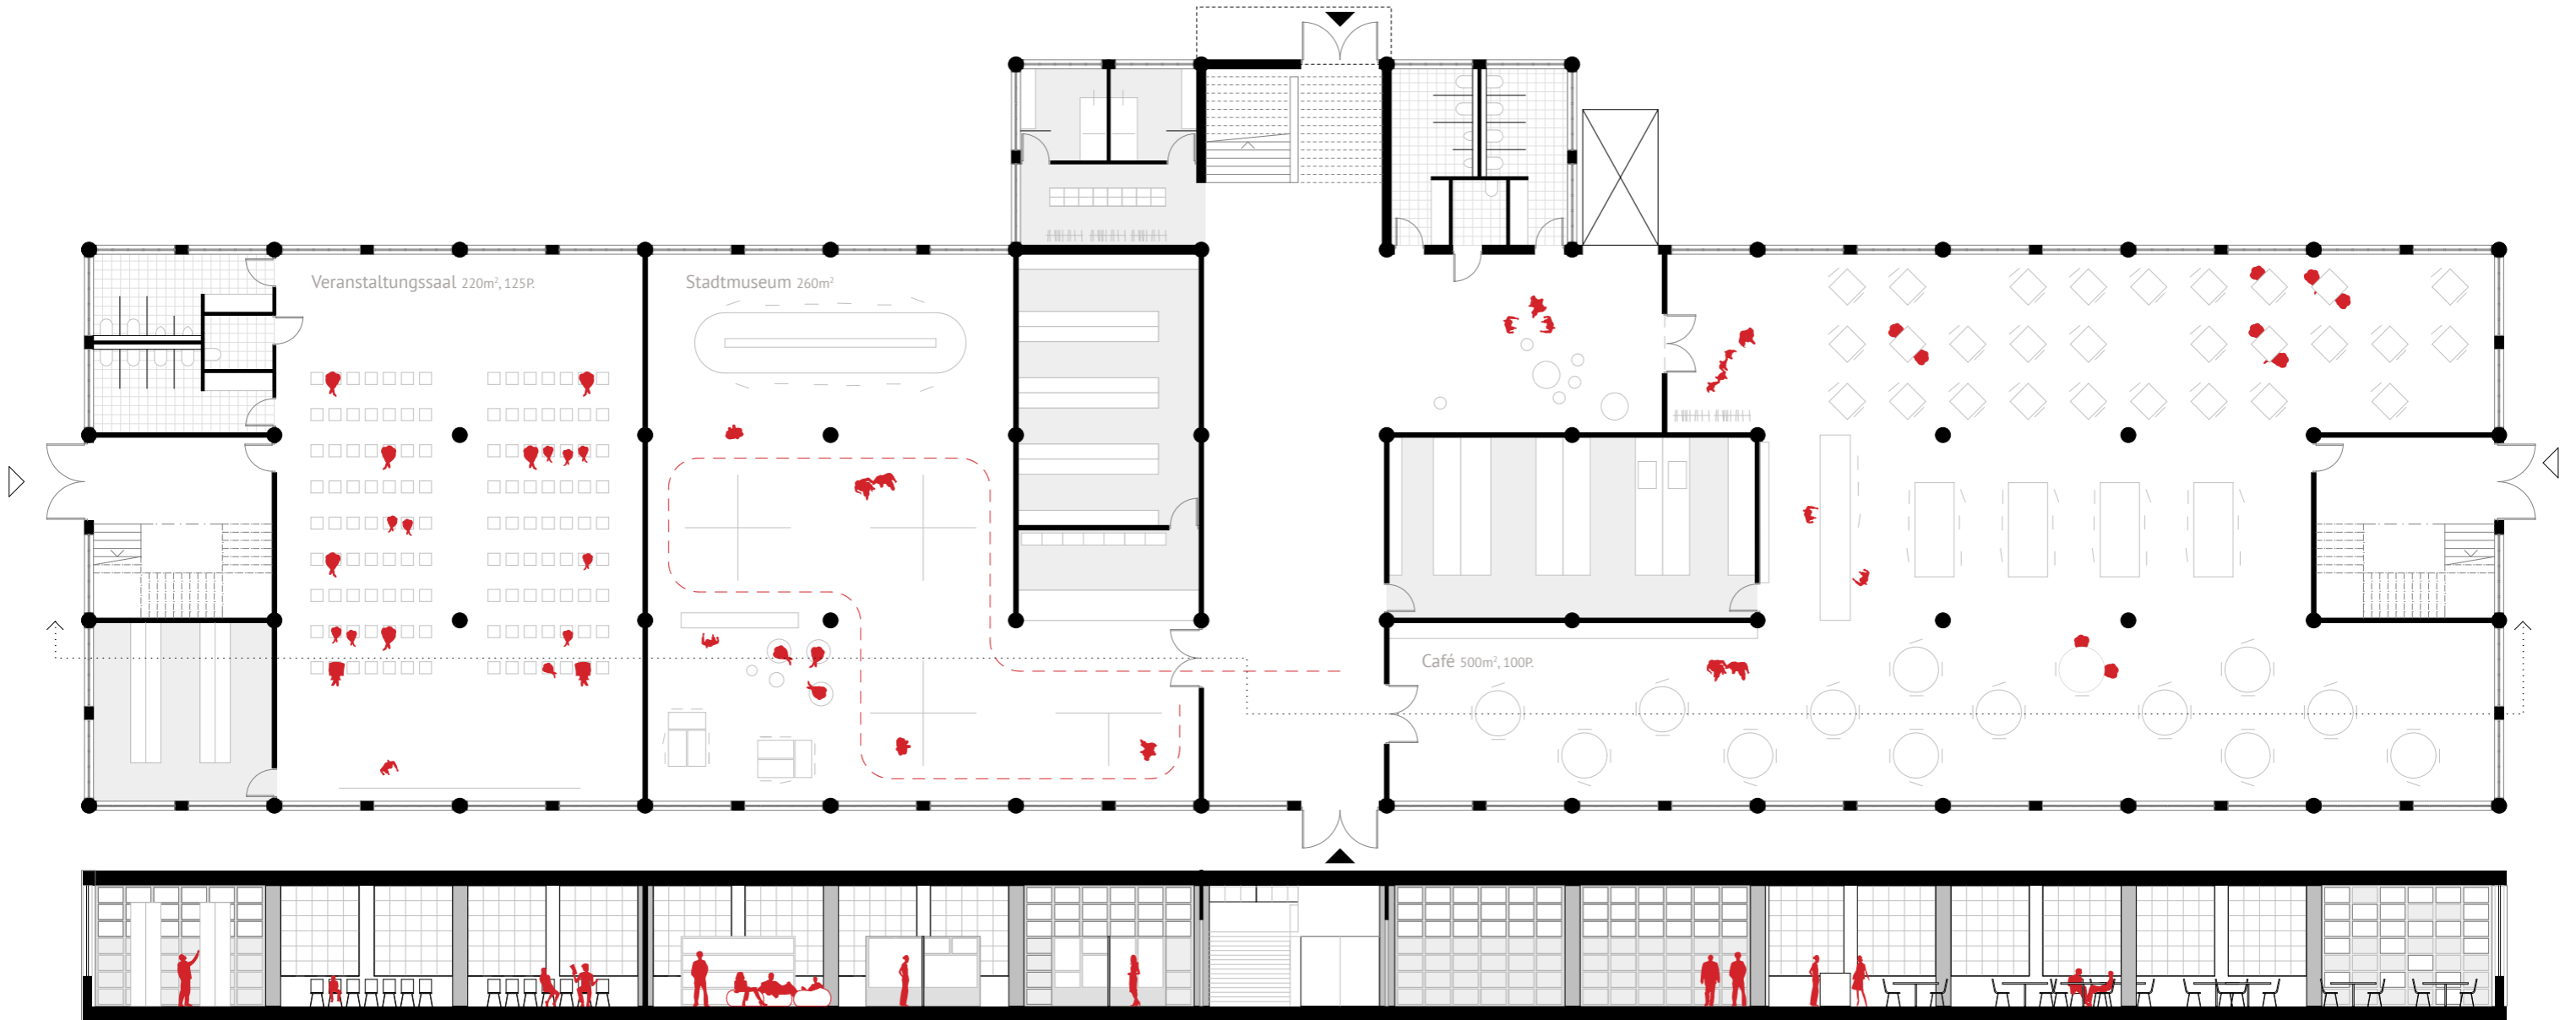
Grundrissvariante mit Räumlichkeiten >100 m²
